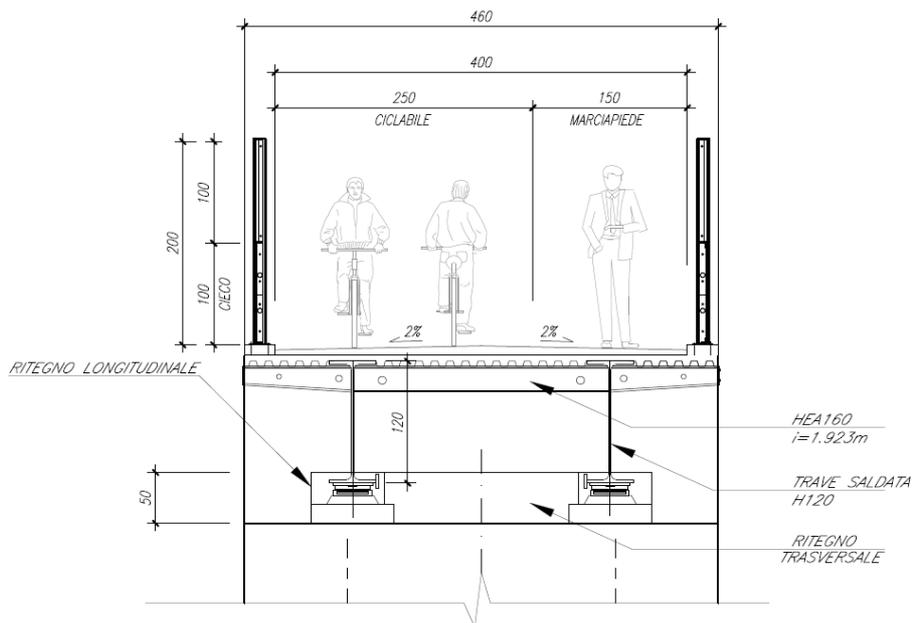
Sezione trasversale tipo dell'impalcato: sezione corrente
